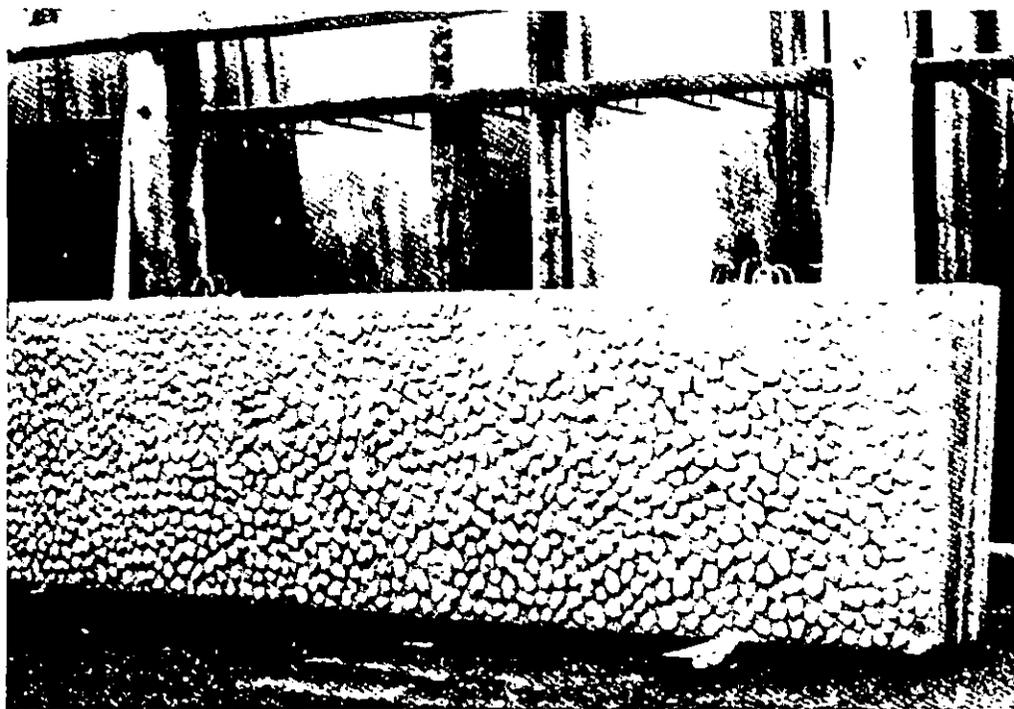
b) Acabado en panel con enchape de piedra. Aplicación en vivienda multifamiliar.
